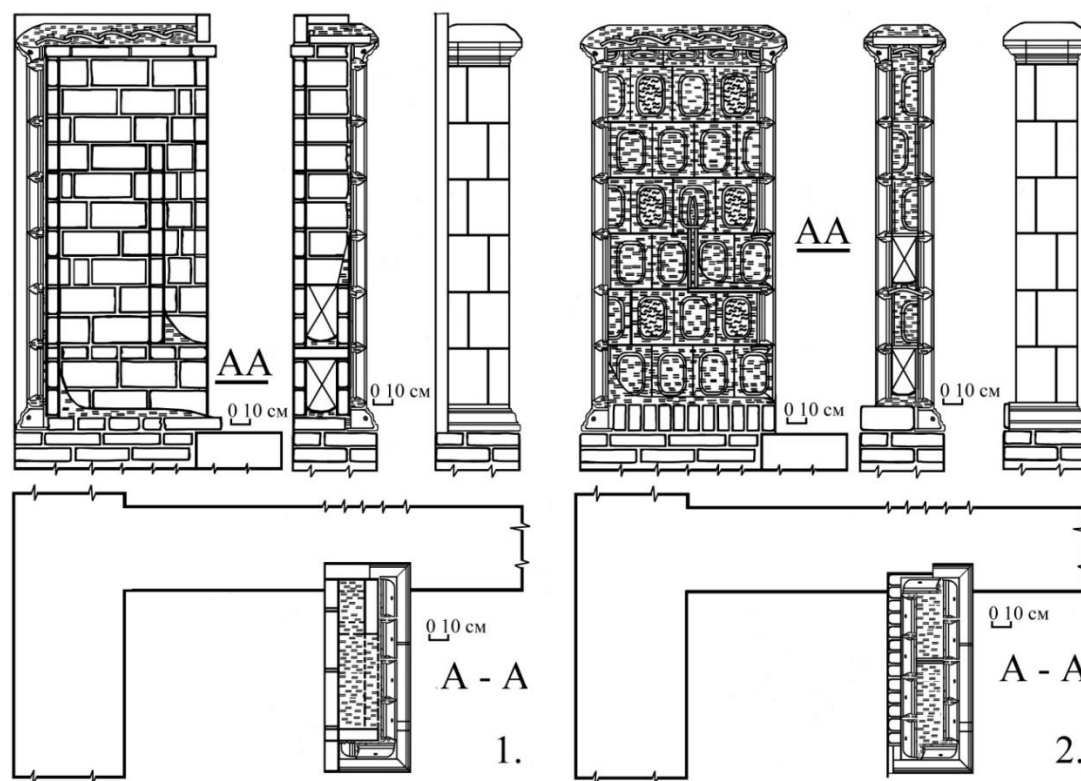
Варианты реконструкции отопительного щитка с фрагментами внутренних стен углового здания XVIII в.
